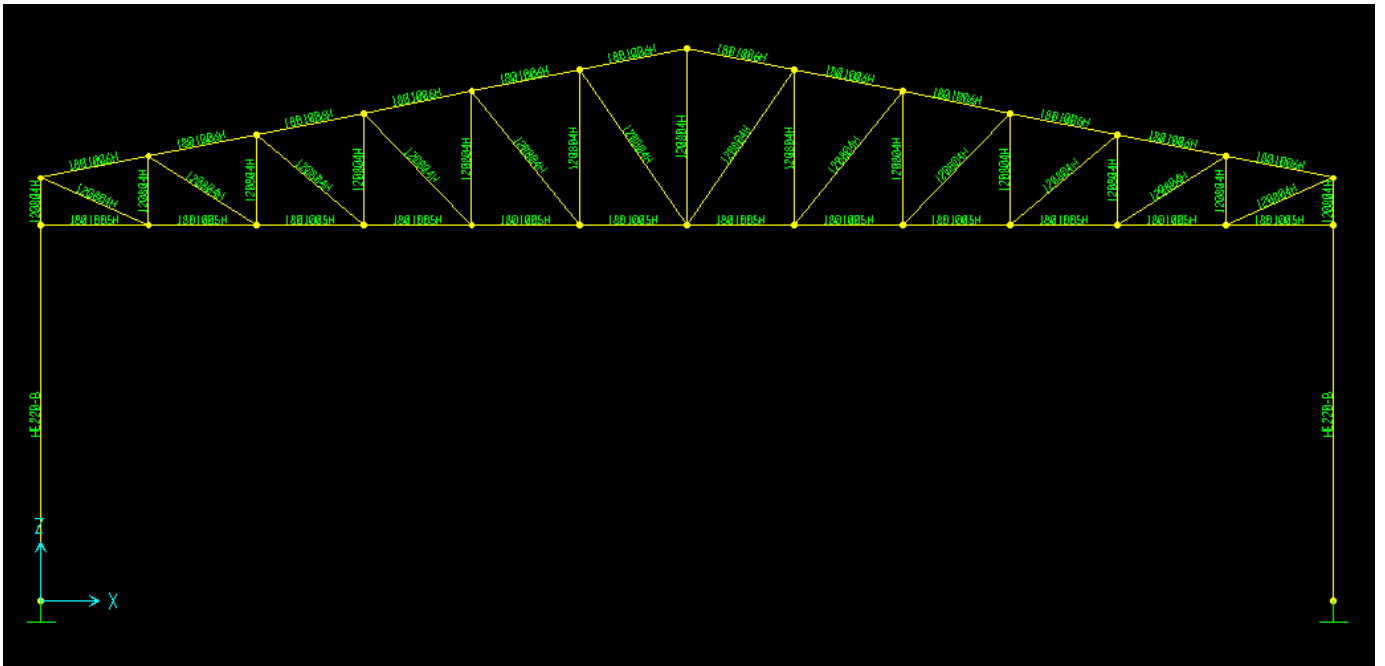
Diseño de la estructura de cercha sobre pilares en SAP2000.
